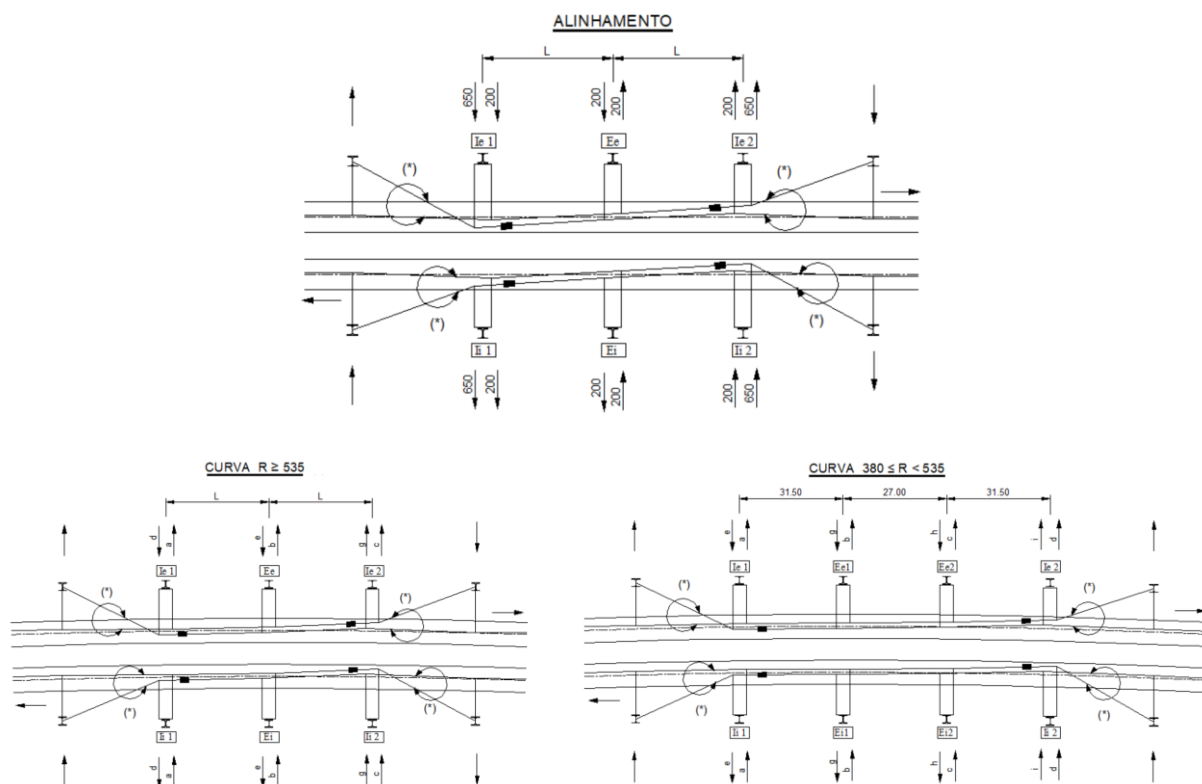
Seccionamento de lâmina de ar – piquetagem em alinhamento reto
